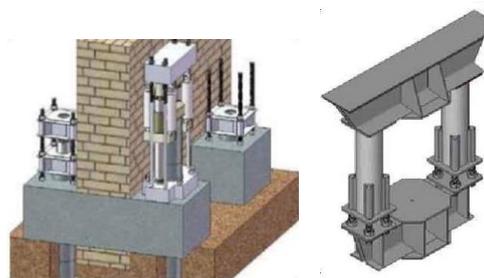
Схема усиления фундамента секционными сваями и устройство фиксации предварительного напряжения свай с упором в подошву ростверка
